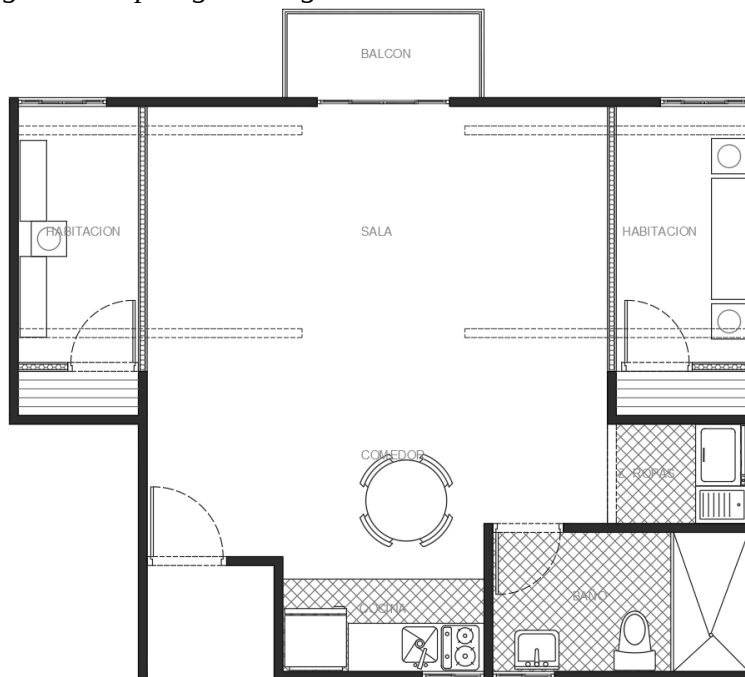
Planta general Tipología 1 Organización 3Figura 78. Planta general Tipología 1 Organización 4
